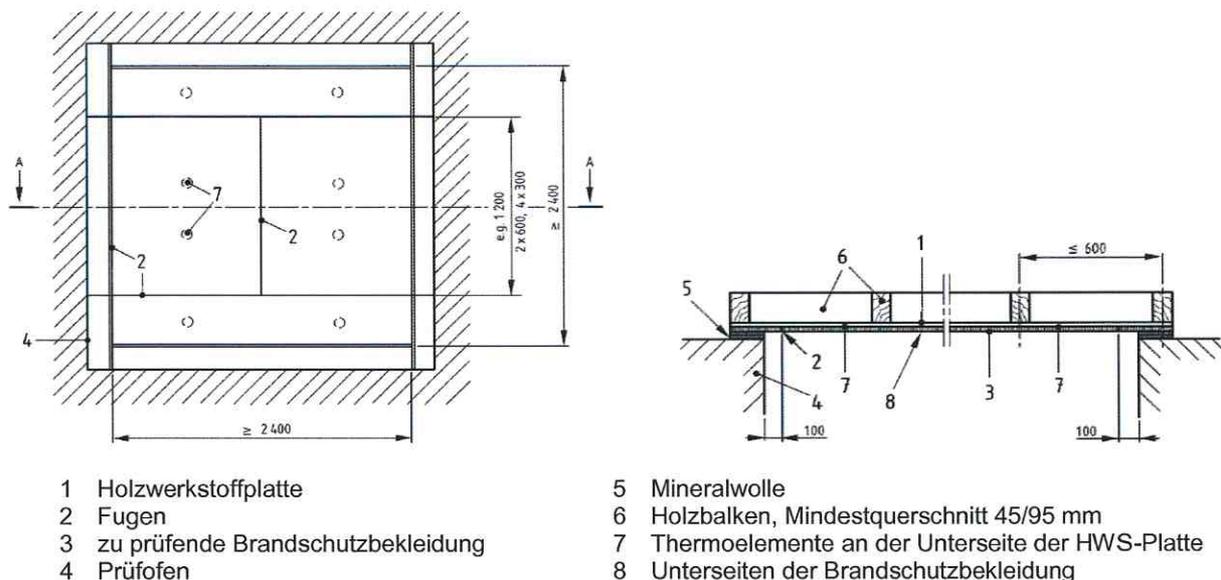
Prüfaufbau einer Brandschutzbekleidung nach DIN EN 14135
